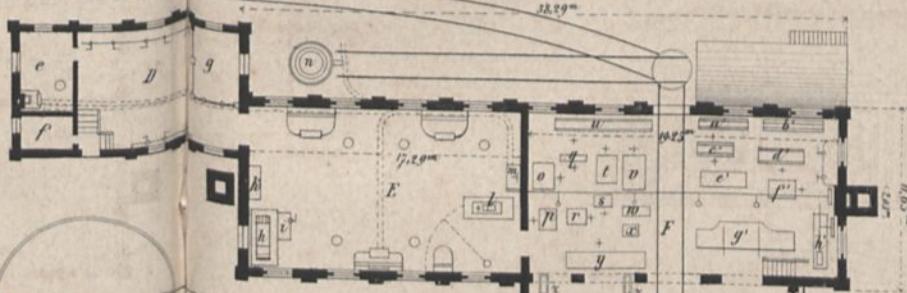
Grundriss rechts mit der Reparaturwerkstätten doppelten Maasse
